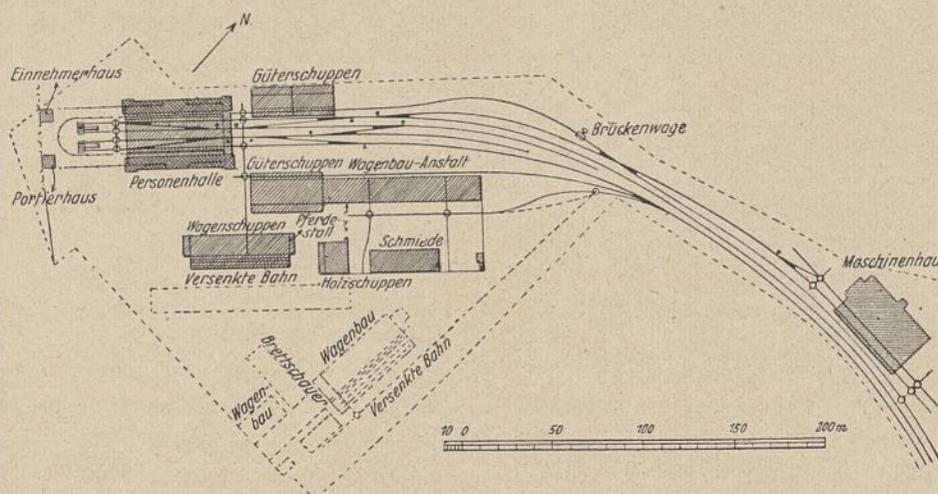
Lageplan der Leipzig-Dresdener Bahn in Leipzig (1840).
